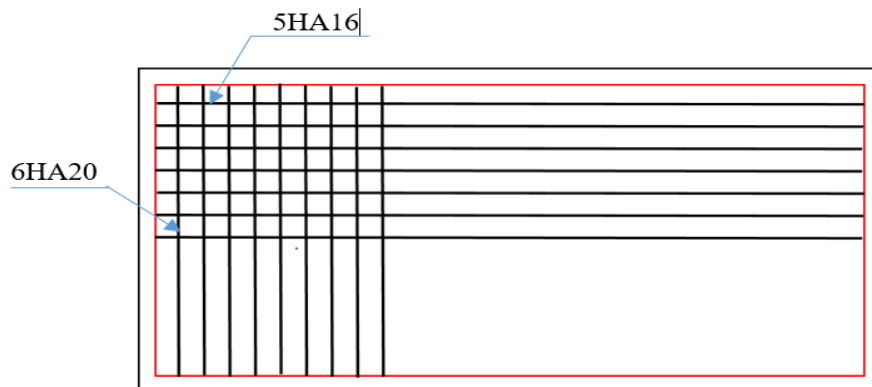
FERRAILLAGE DE LA NAPPE SUPERIEUR DE LA SEMELLE
